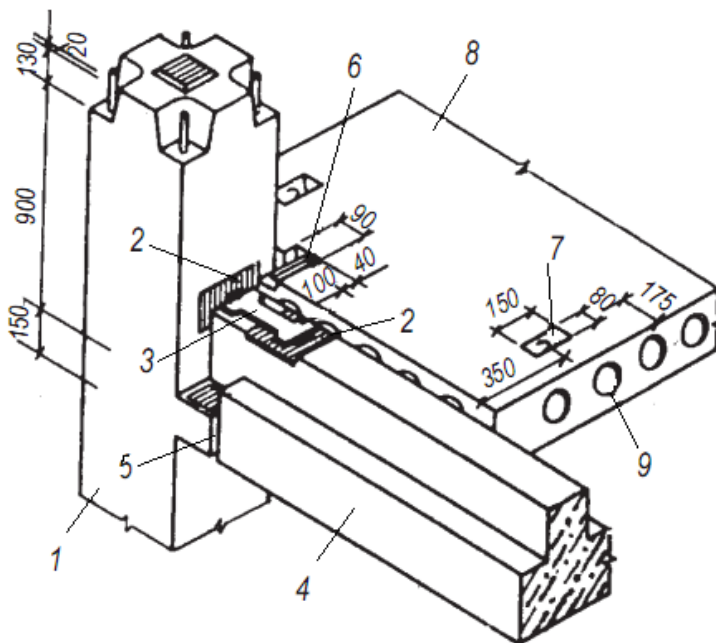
Вузол з'єднання ригеля з колоною рами збірного залізобетонного зв'язкового каркаса: 1 – колона; 2 – закладна деталь; 3 – сполучна планка «рибка»; 4 – ригель; 5 – цементний розчин М200; 6 – підрізка з випуском арматури 2Ø14 для зварювання зі сполучною планкою «рибка»; 7 – петля; 8 – залізобетонна пристінна плита; 9 – ніша розчинної шпонки Ø120 з кроком 200 мм
